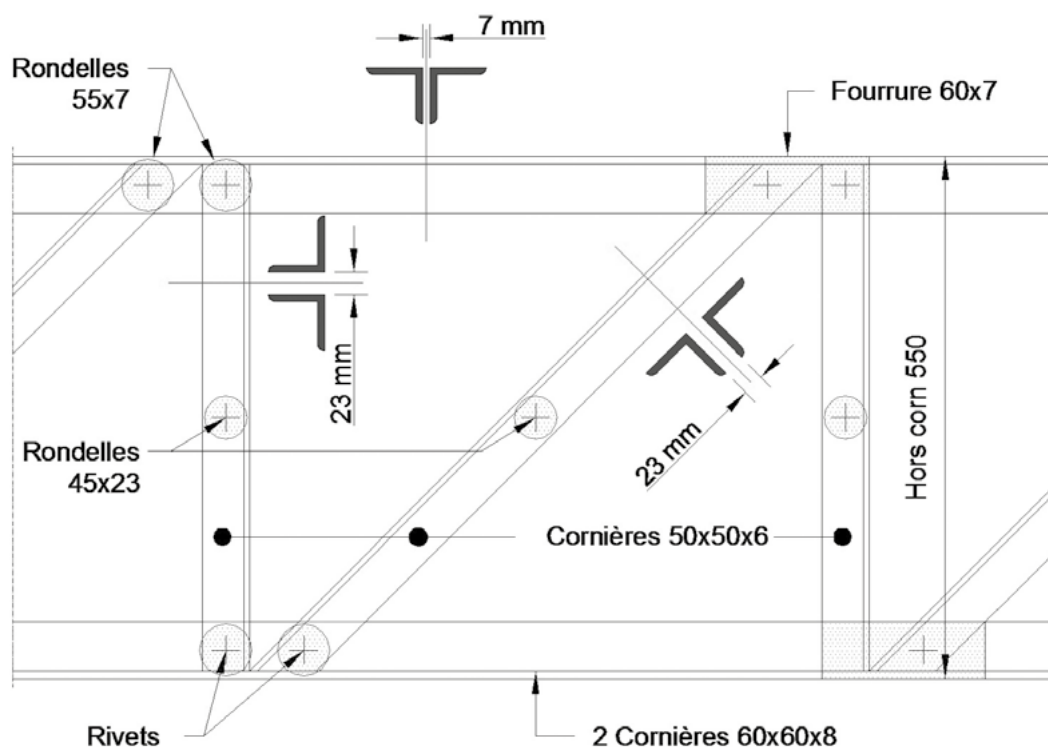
Nœud supérieur d'une poutre de hauteur moyenne (exemple)
